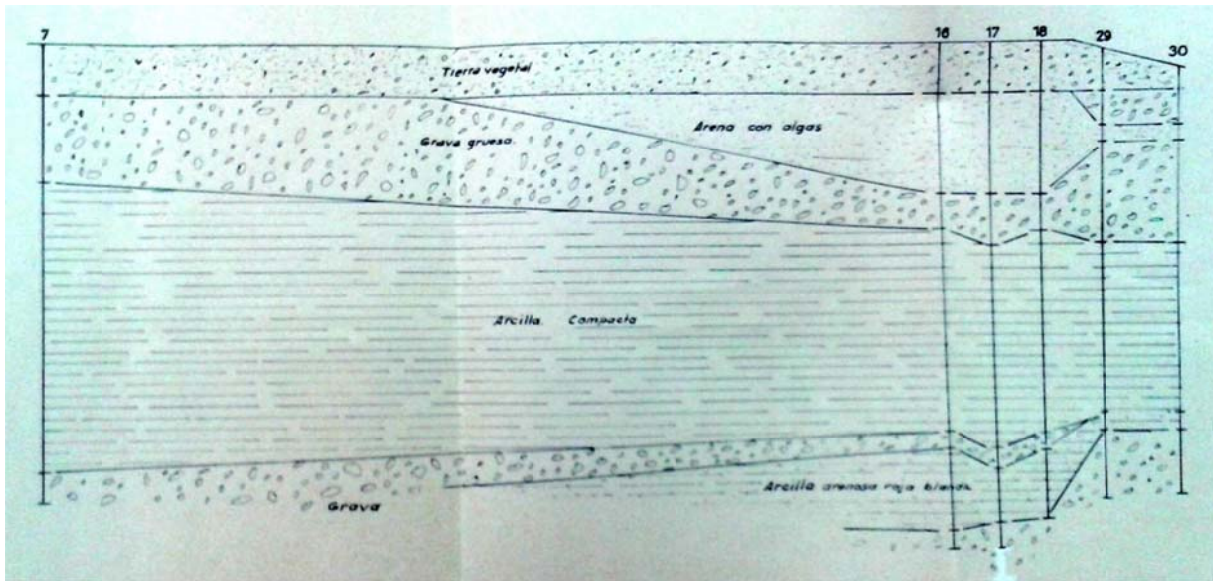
Estratos de cimentación 3. (Sondeos Inyecciones Pilotes, S.A., 1960)
